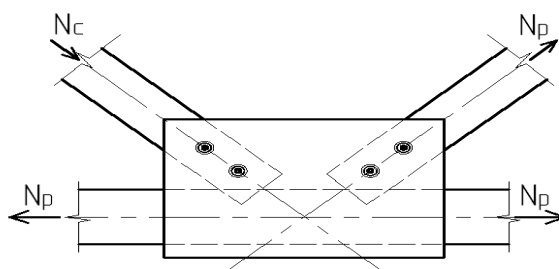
Крепление раскосов к нижнему поясу
